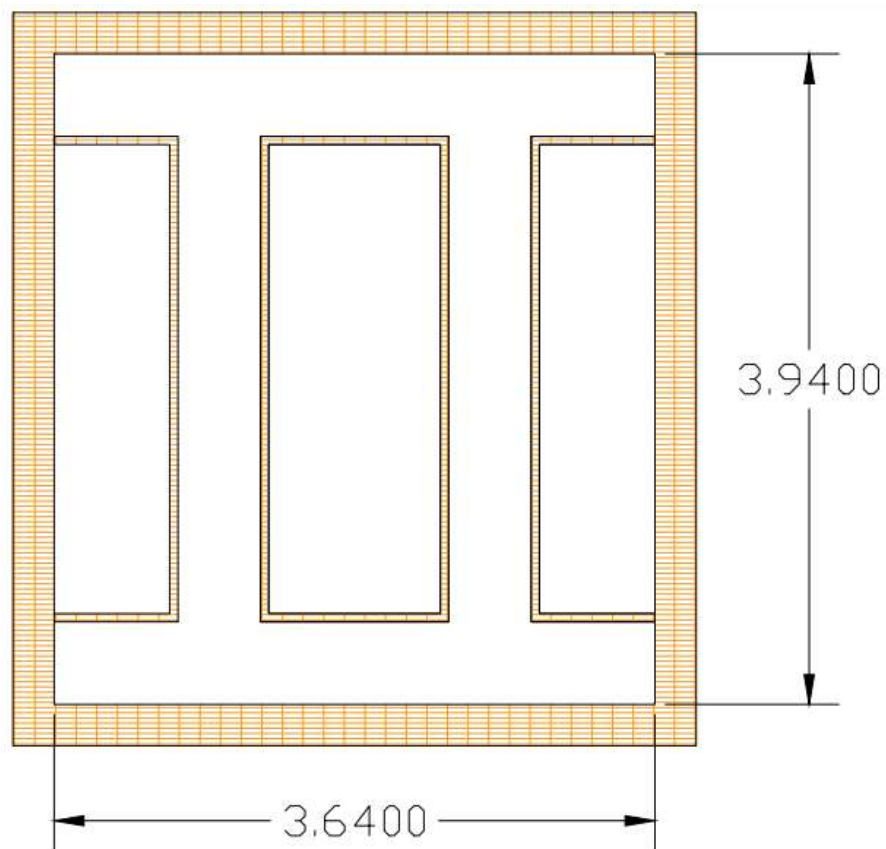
Esquema vista en planta sistema existente de filtración. Fuente: Autor
